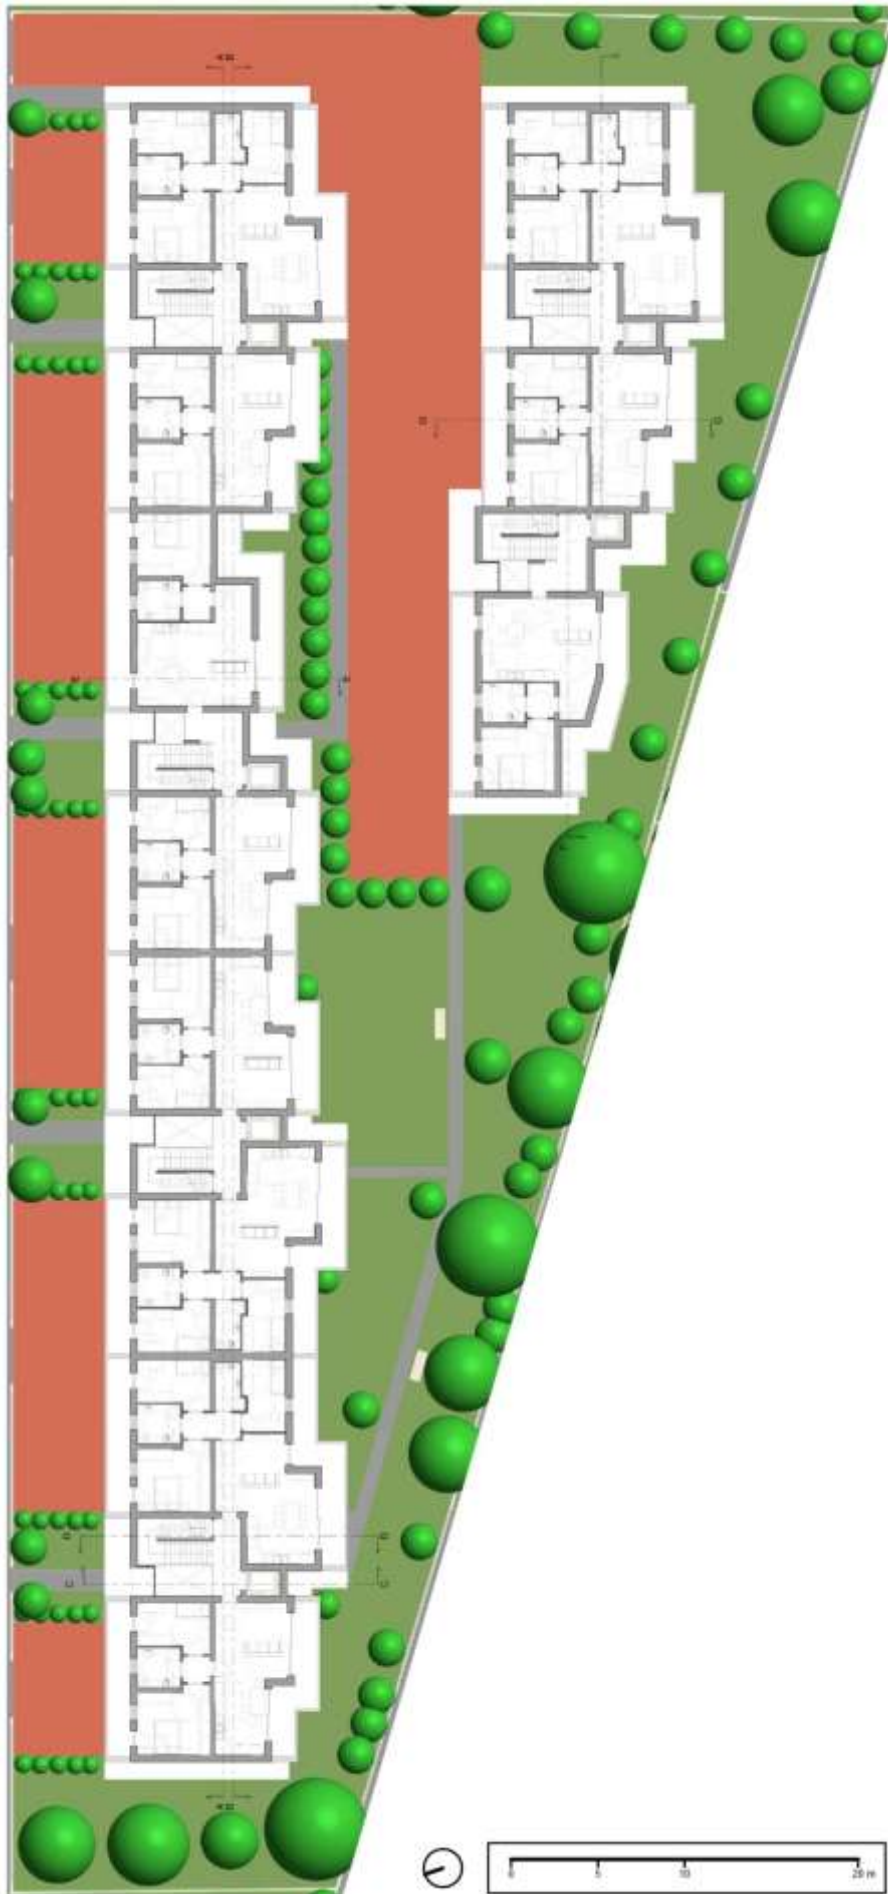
Masterplan P02. [Fonte: elaborazione dell'autore]
